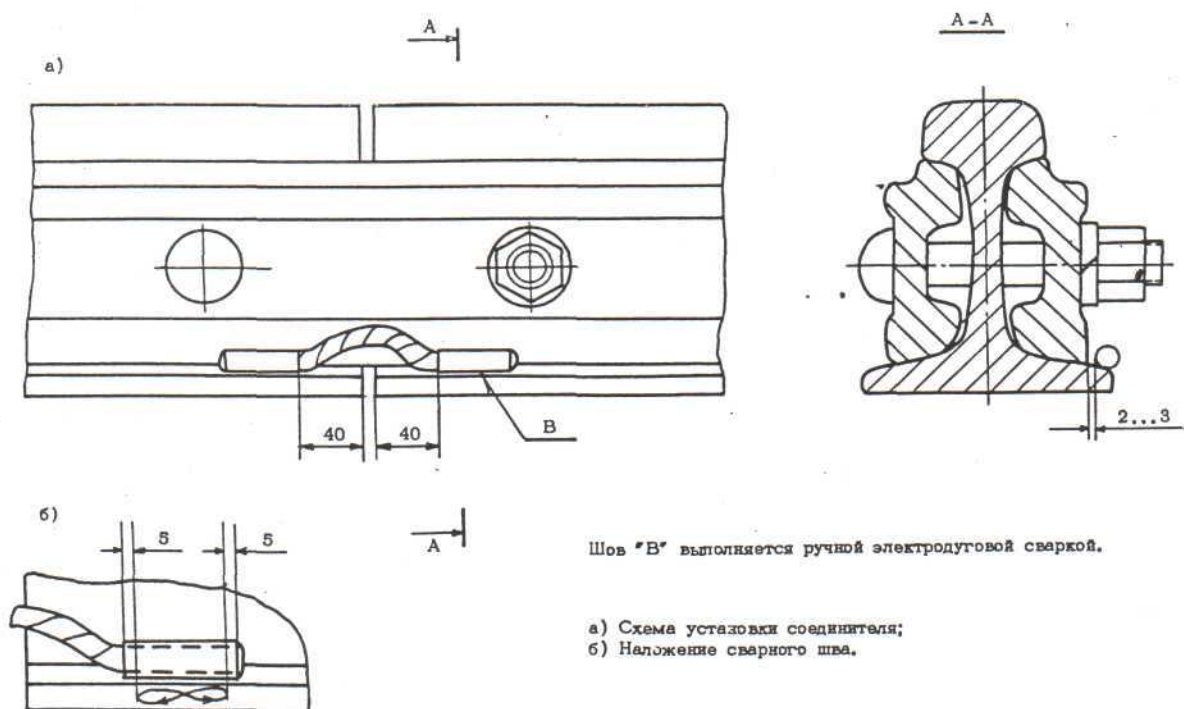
Установка и приварка соединителя к подошве рельса
